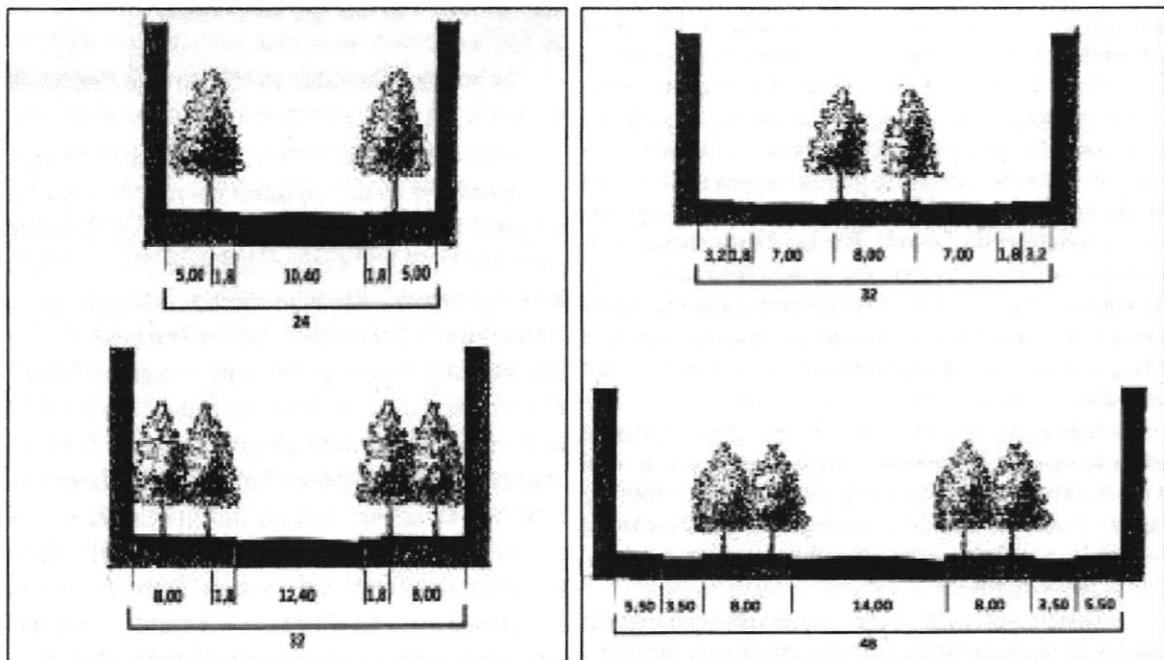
Plantation et profils des boulevards selon la portée.
